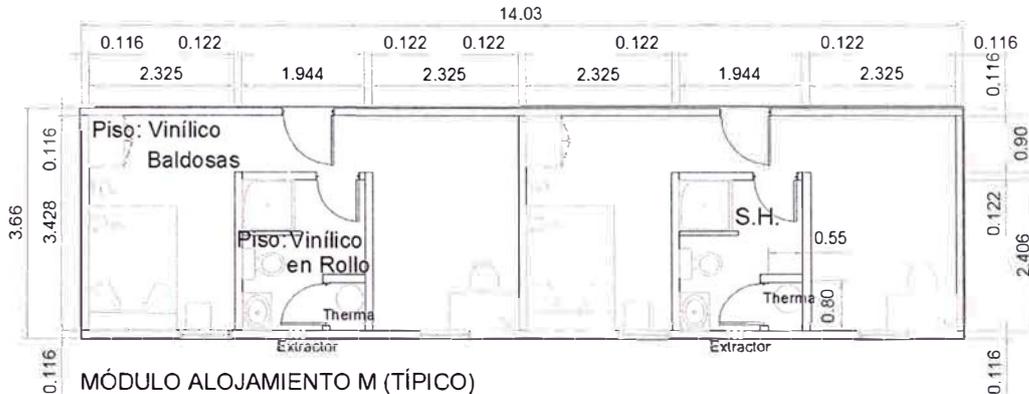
Vista en planta de módulo de alojamiento manager
